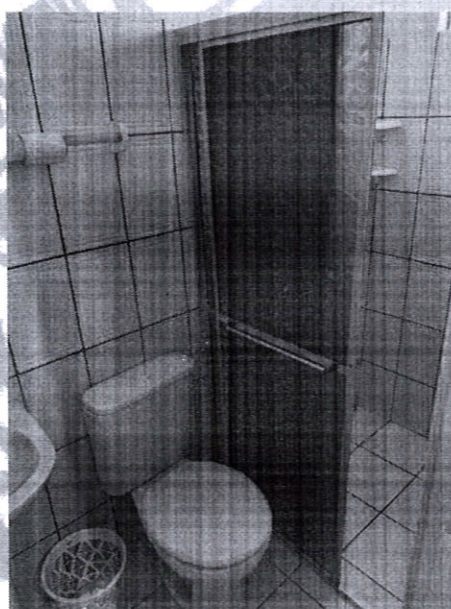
Vistas de outro banheiro em bom funcionamento.
